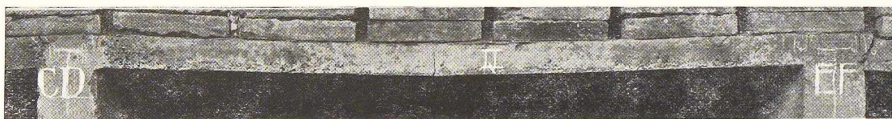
Hourdis en béton de porphyre (fig. 1). Etat de la dalle de la travée centrale, au moment où l'on a interrompu l'essai à cause de l'état des travées latérales (fig. 12). Les fissures étaient celles indiquées (fig. 11).
